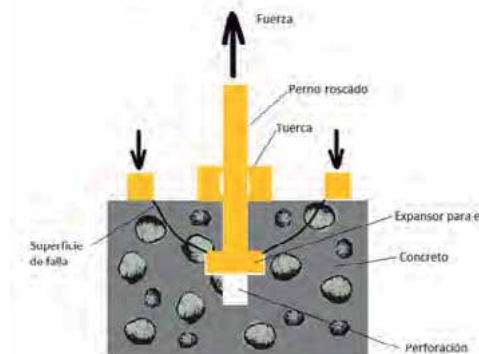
Ensayo de Pullout en mampostería de concreto
